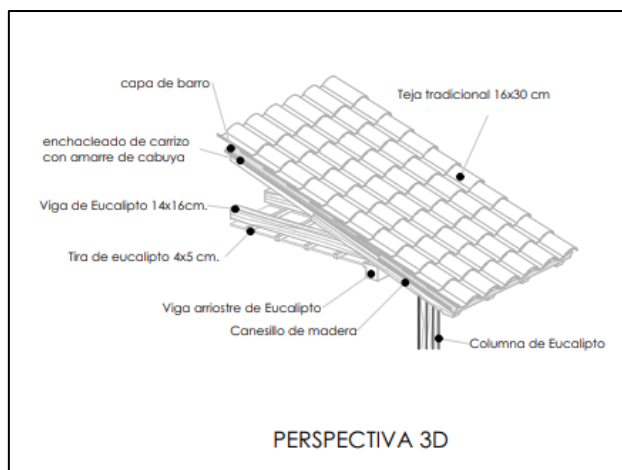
Detalle constructivo del sistema de cubierta. Fuente: Tomado de: Caldas y Sigcha (2017)
